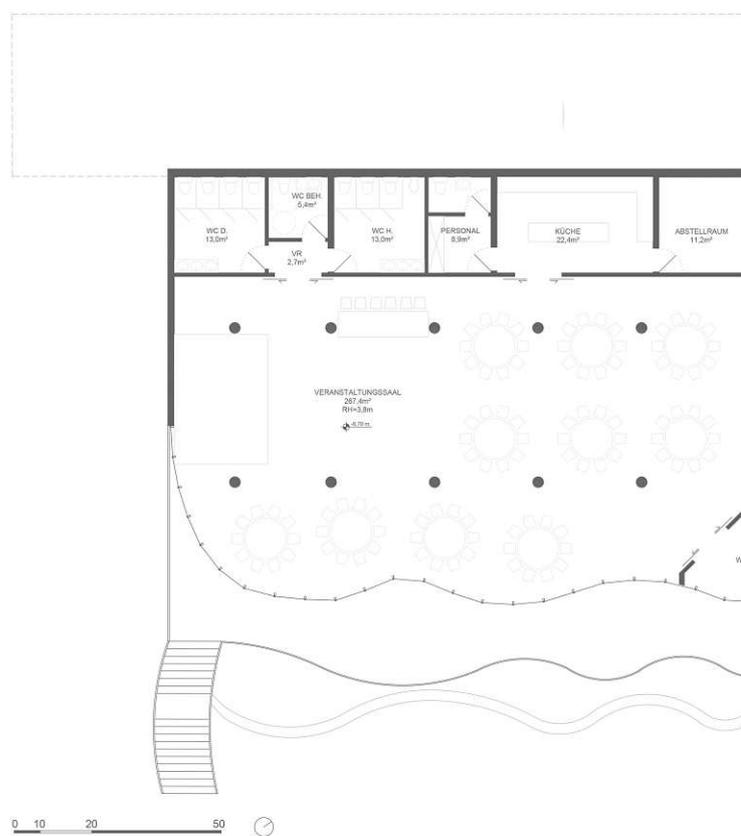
Grundriss 2. Untergeschoss
